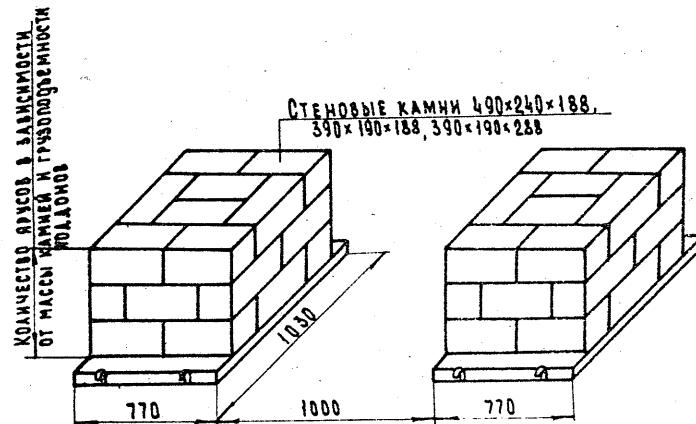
Складирование стено́вых камней из горных пород на поддонах
